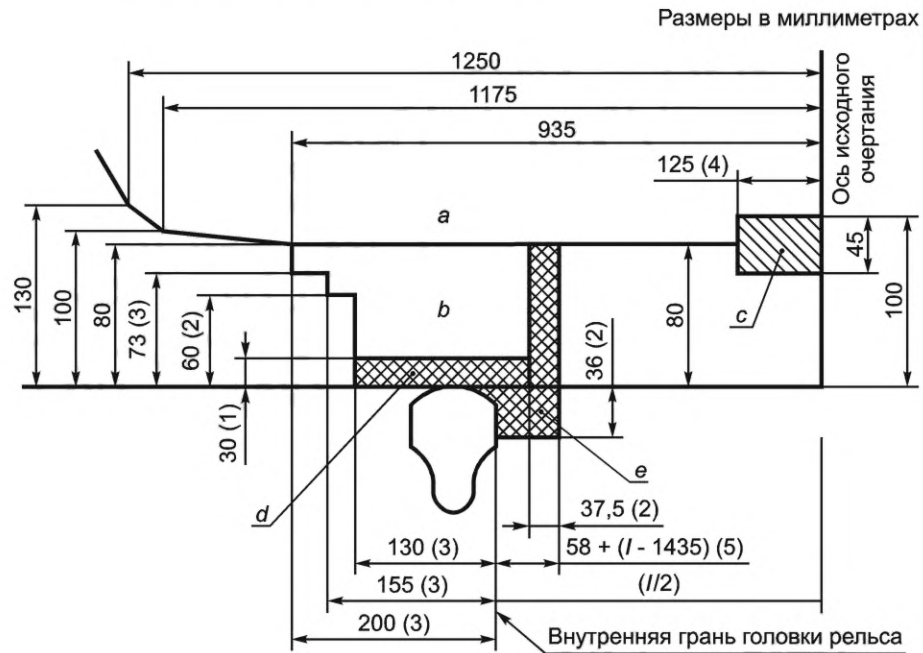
Нижнее очертание габарита для подвижного состава, проходящего по сортировочным горкам, оборудованным вагонными замедлителями при их любом положении
